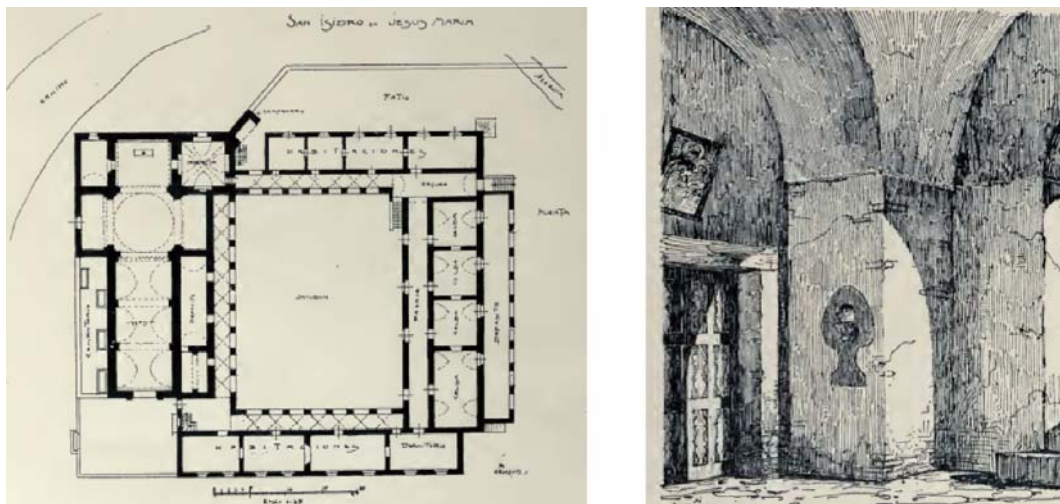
Izquierda, planta de la estancia de Jesús María -mezcla planta alta con la planta baja e incorpora una cruja inexistente hacia abajo de la imagen para cerrar deliberadamente el claustro-. Derecha perspectiva interior de la sacristía. Nótese la escalera hoy demolida. (Kronfuss, 1920)
